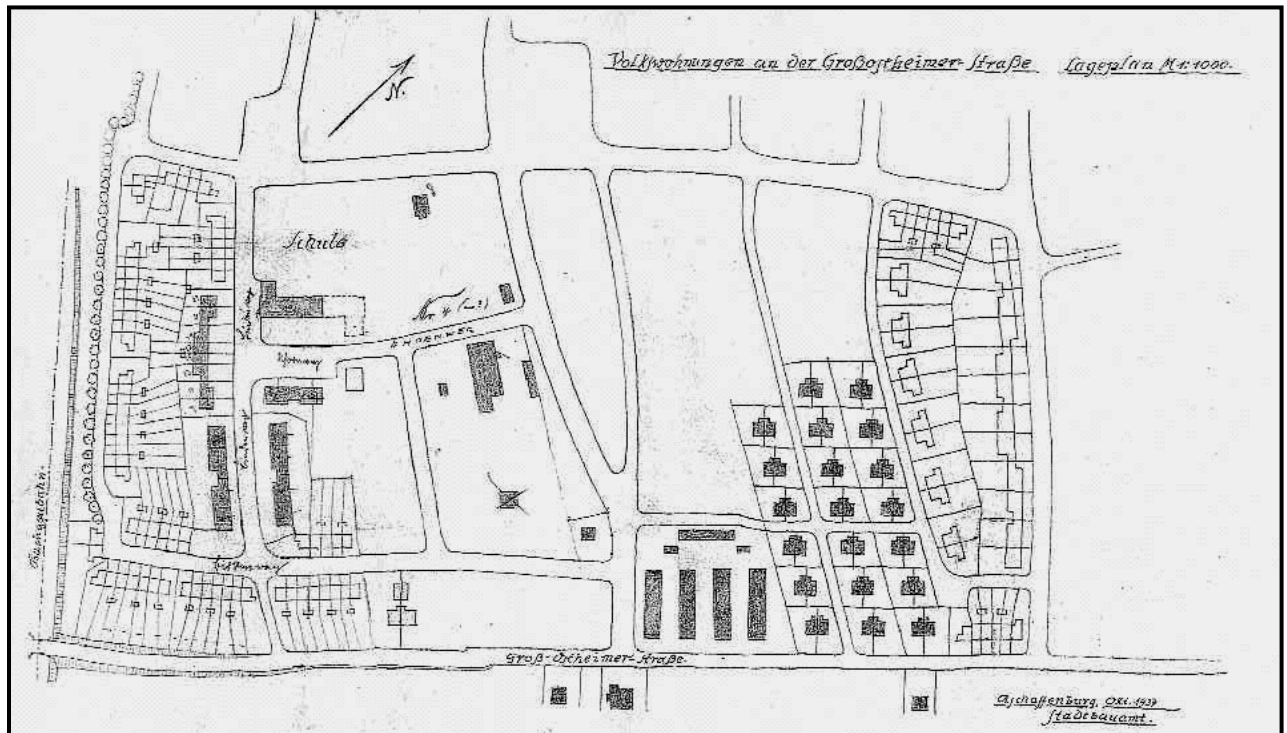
Lageplan zum Bau von Volkswohnungen, Stadtbauamt Aschaffenburg 1937
